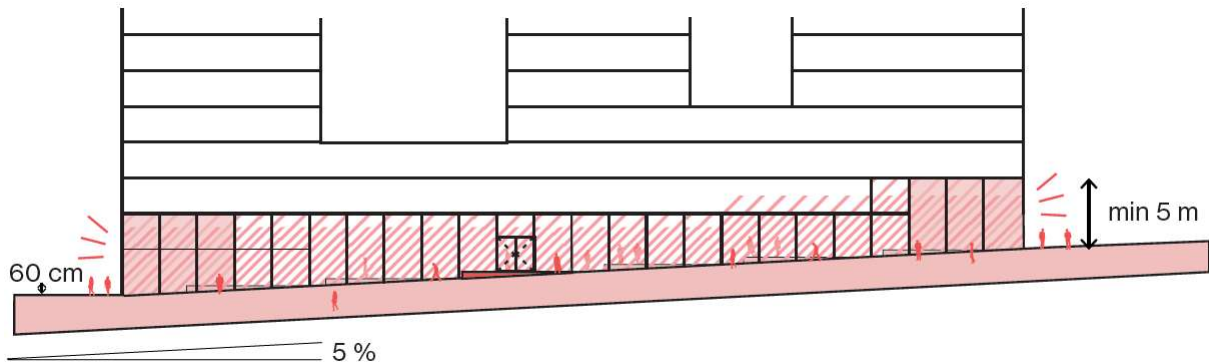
Traitement des rez-de-chaussée en pente du parvis de Beaulieu (ORG², 2018)
